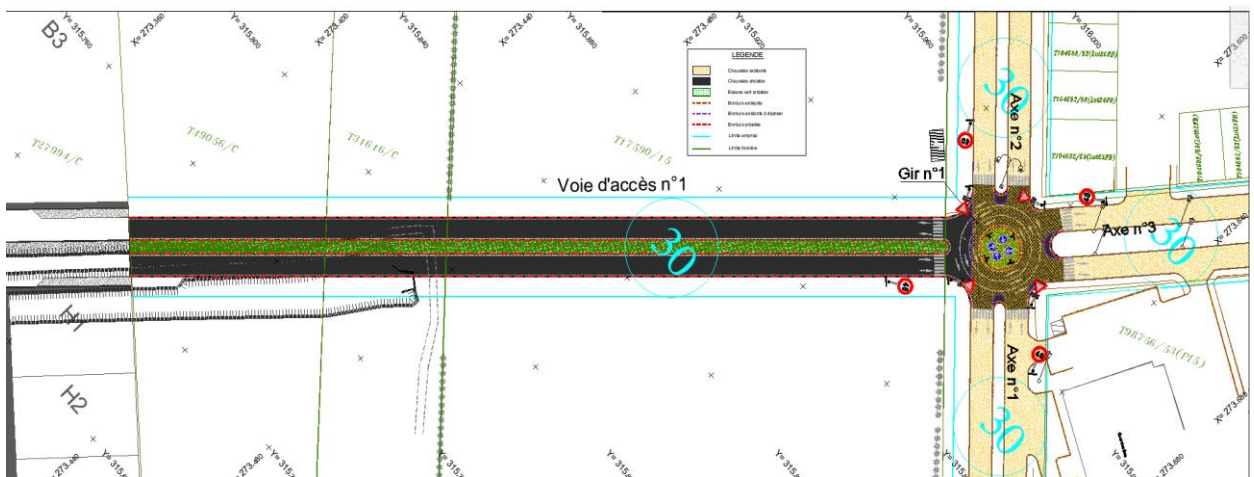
Tracé en plan de la voie d'accès N°1 et carrefour – Extension de la ZI Had Soualem.
